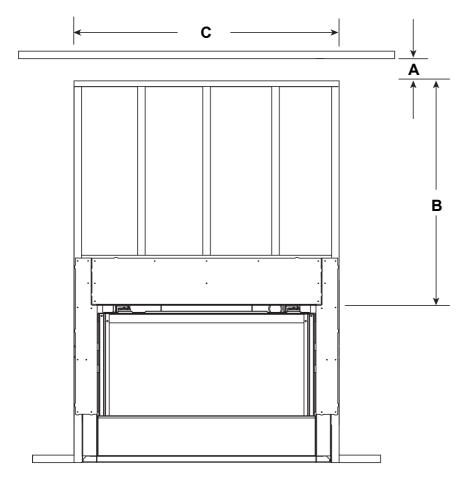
Dimensions de la charpente - Chaleur passive échappement latéral
